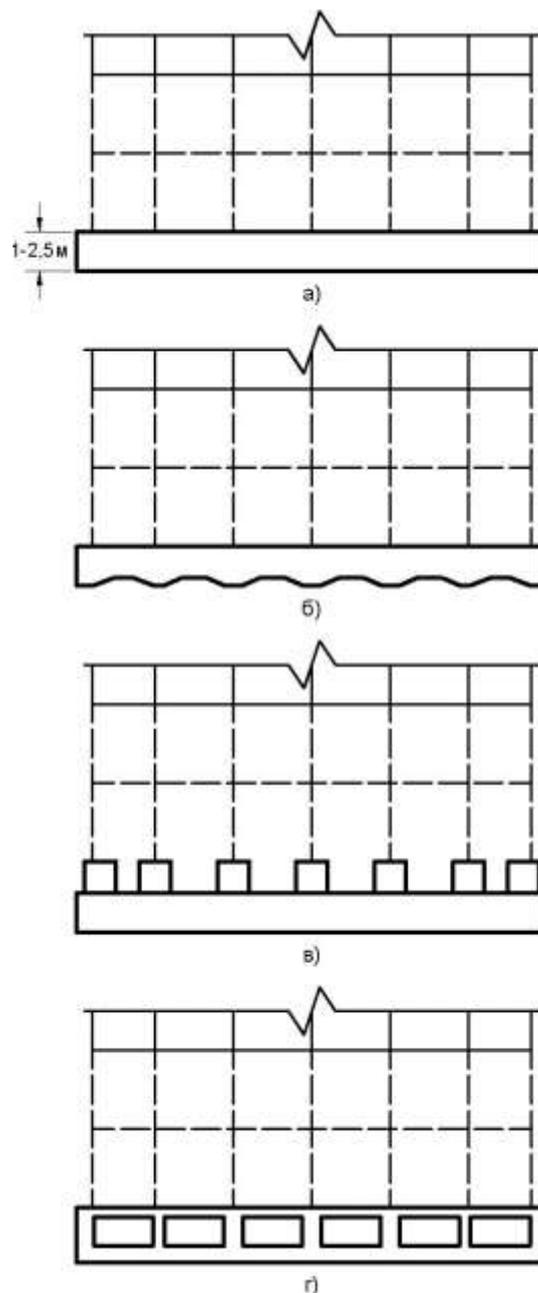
Конструкции сплошной монолитной железобетонной плиты:
